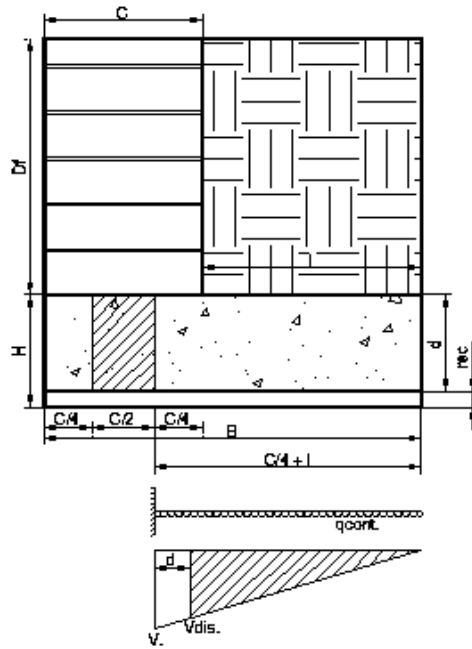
Croquis para el diseño estructural de una zapata de lindero.
